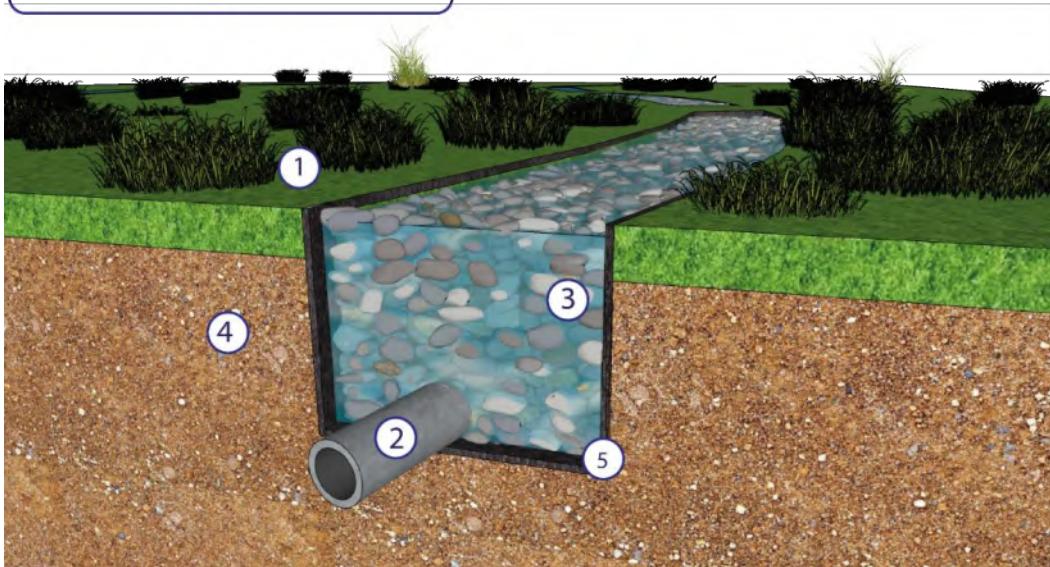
| Detalle de Zanja de Infiltración o Dren Francés, diagrama elaboración propia
